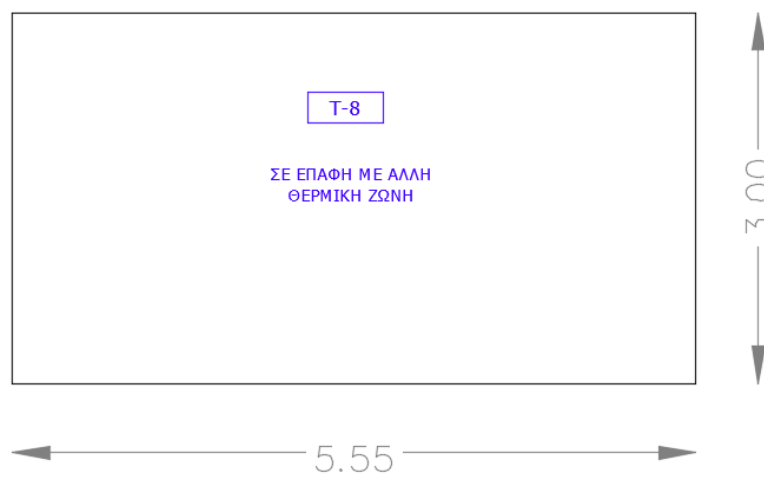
Όψη Νο5 στην κάτοψη ισογείου, AutoCAD
